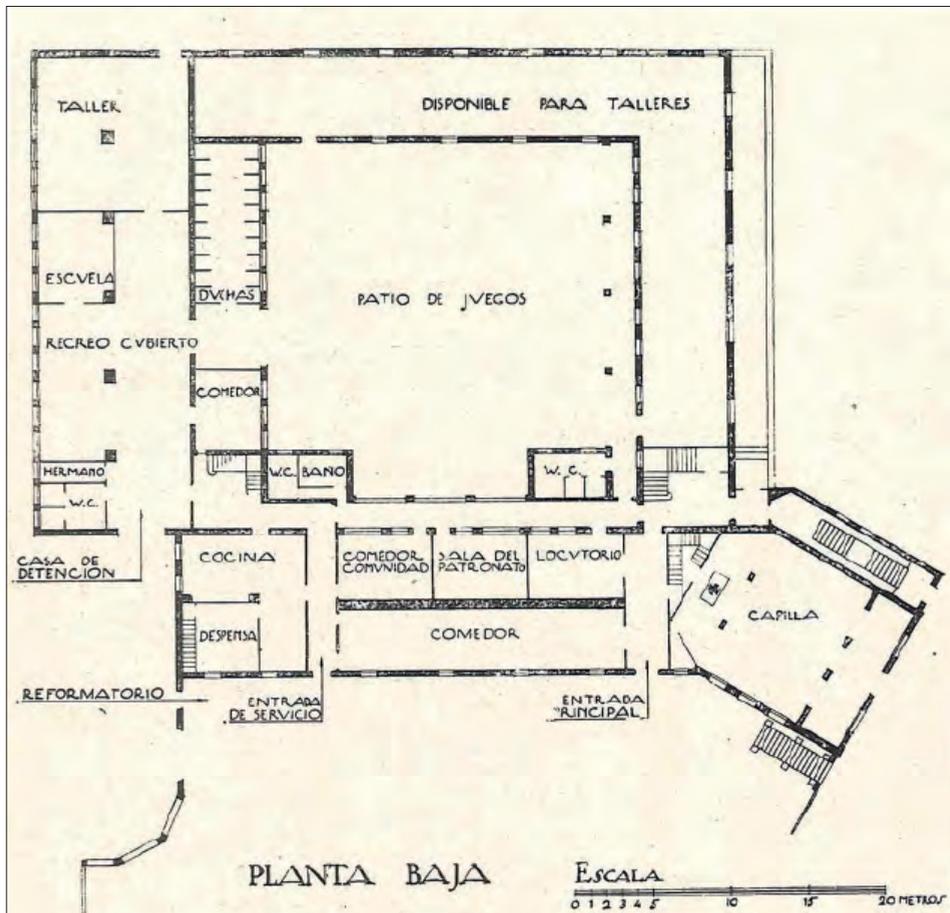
Plano. Planta baja del Buen Pastor, 1921 (ABAU).
